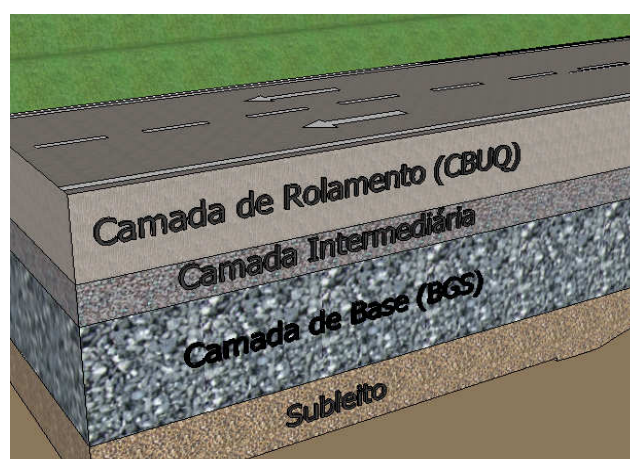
Estrutura de pavimento existente no trecho experimental, antes da restauração
